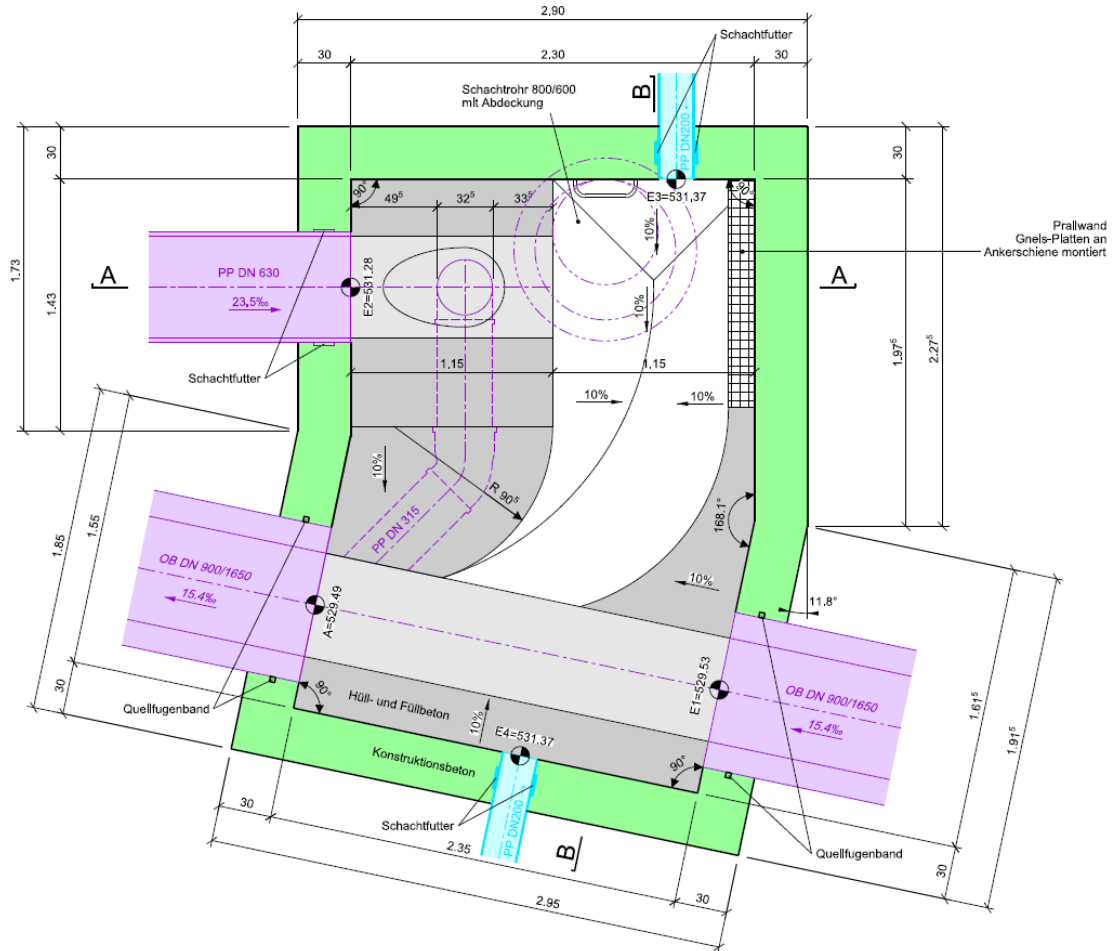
Grundriss des Sonderbauwerkes Nr. 04 (Plan Nr. 60.0433 – 315 - 07)
